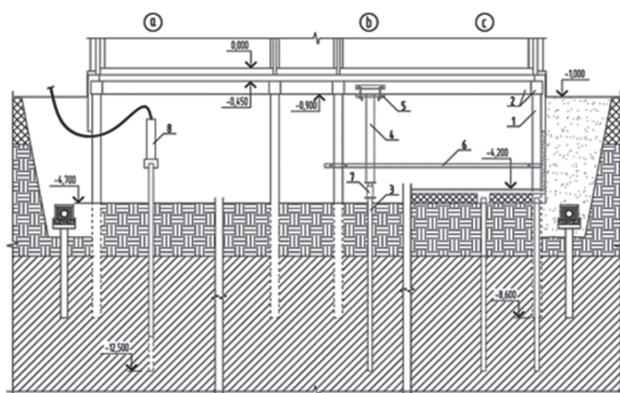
Схема реконструкции подвала здания с применением свай, погруженных пневмомолотом:
